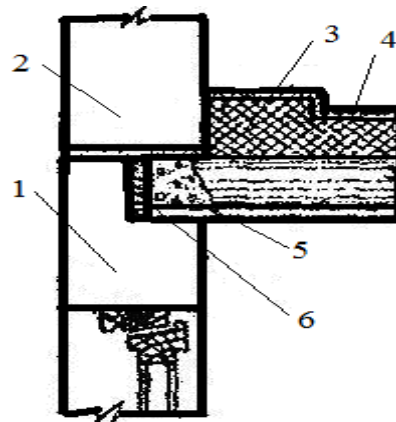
Утеплення горищного перекриття при приляганні до стіни: 1 - стіна над перемичкою; 2 - стіна горища; 3 - теплоізоляційний матеріал; 4 – стяжка; 5 - панель перекриття; 6 - утеплювач.
